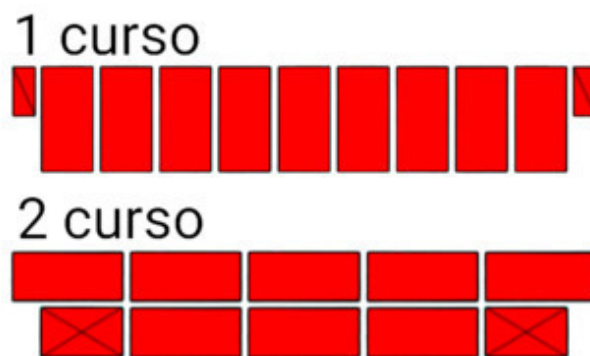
A ordem de colocar tijolos em uma seção de paredes entre as aberturas das janelas. Espessura da parede 1 tijolo.
